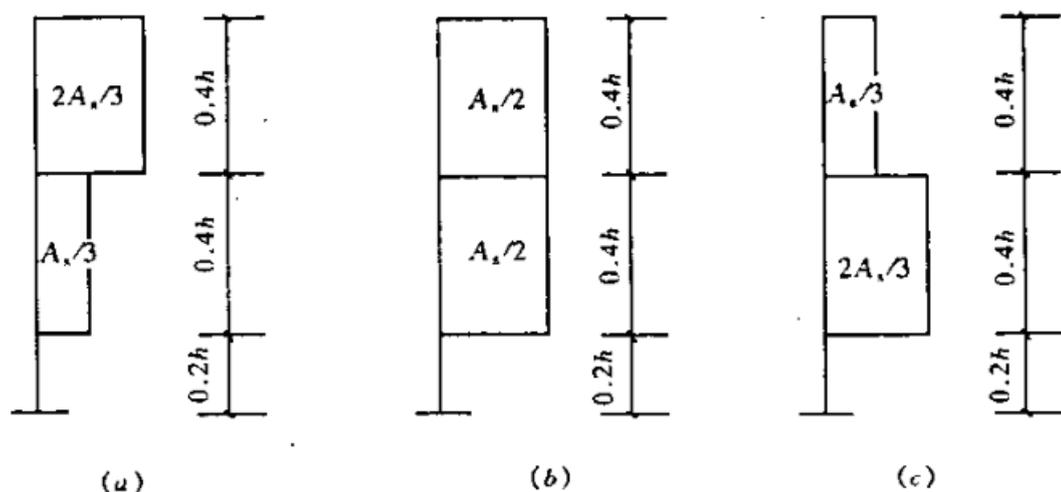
连续深梁中间支座截面纵向受拉钢筋在不同高度范围内的分配比例
